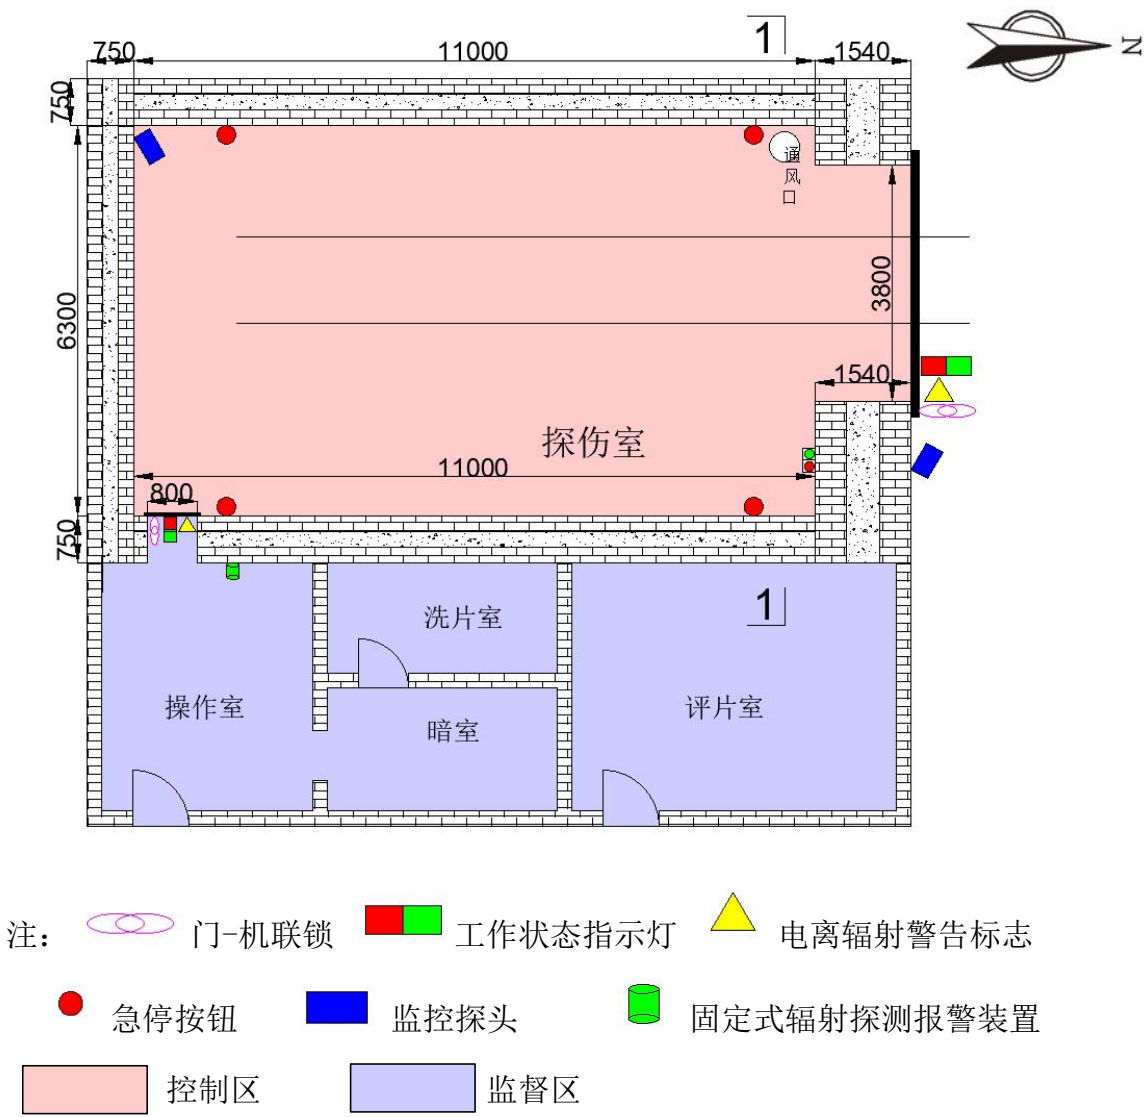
(a) 探伤室平面布置示意图 (单位: mm)
